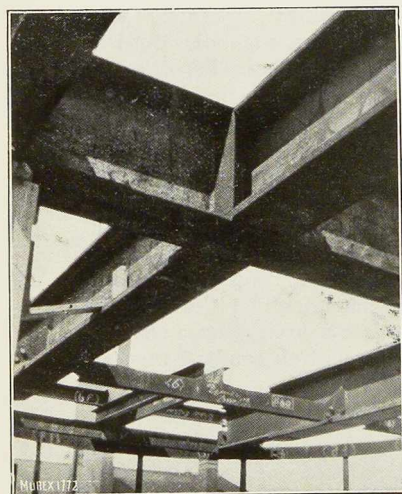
Assemblage de la poutre de rive et d'une des poutres en porte-à-faux de l'escalier nord.
